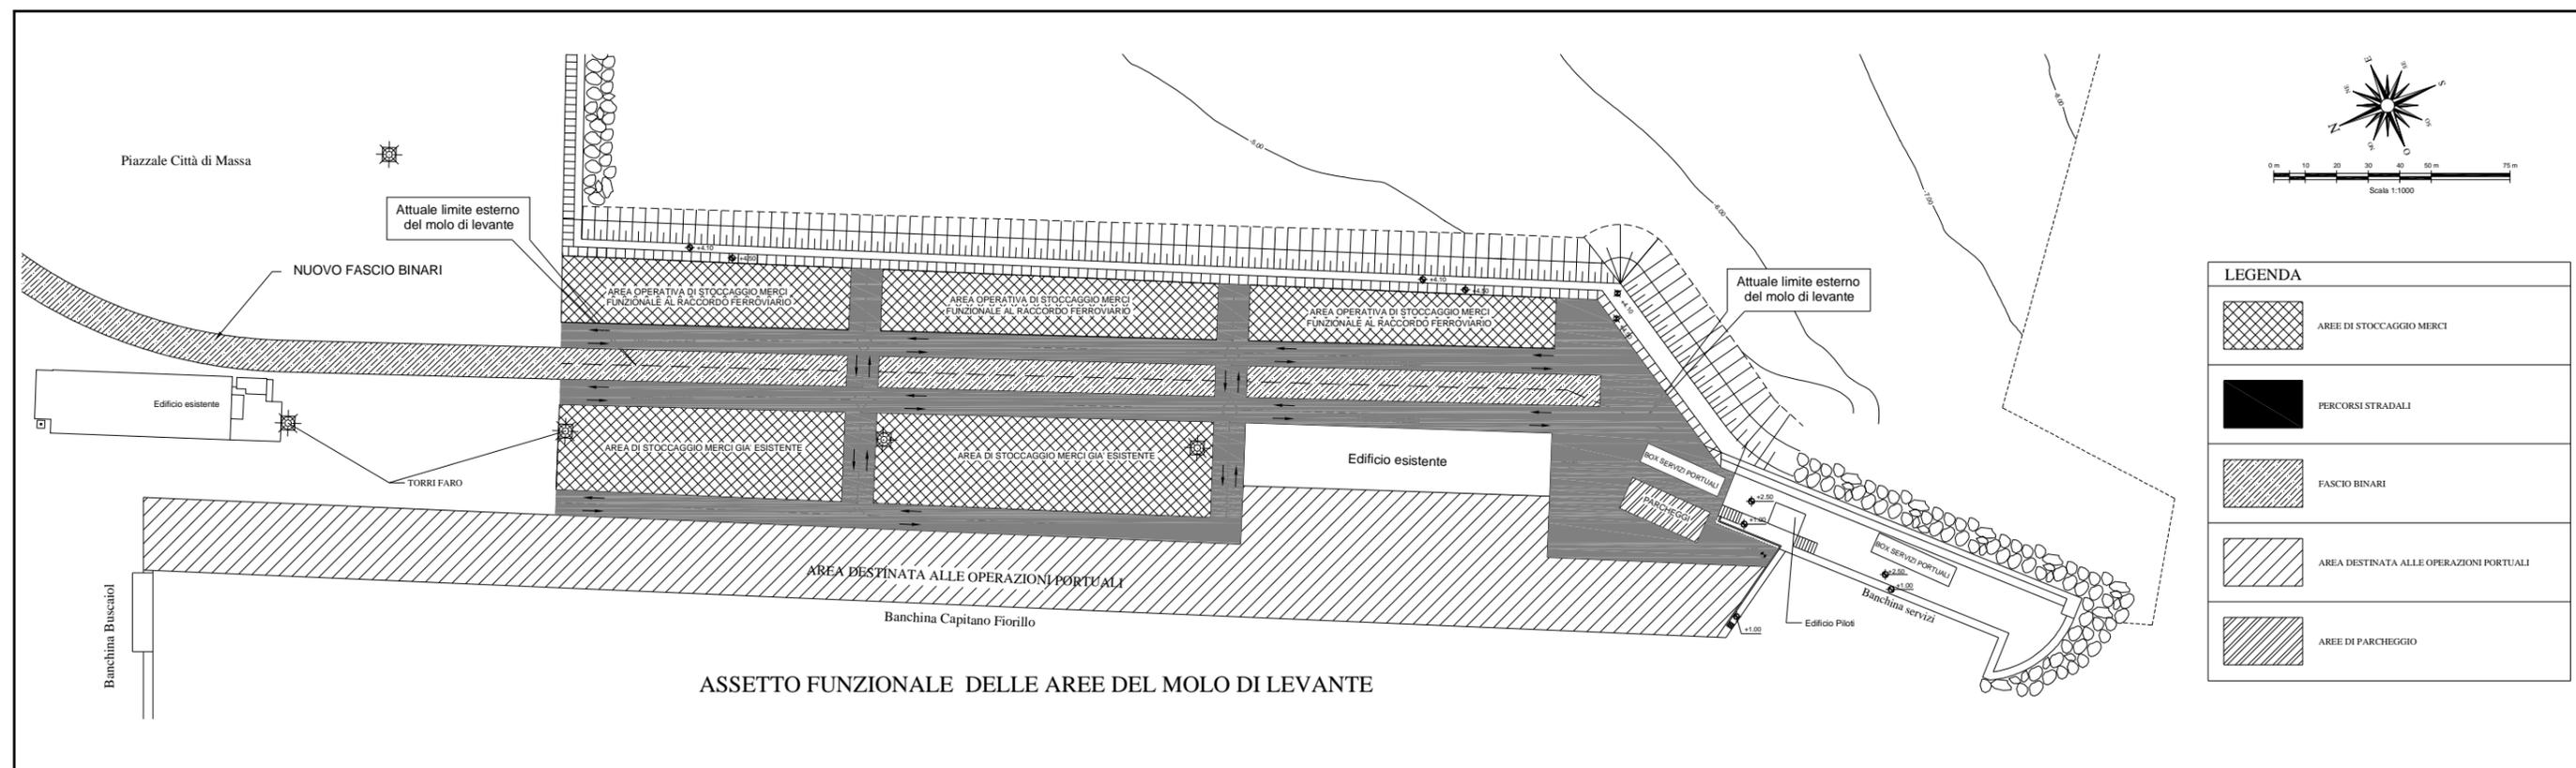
Nuovo assetto funzionale delle aree del Molo di Levante
